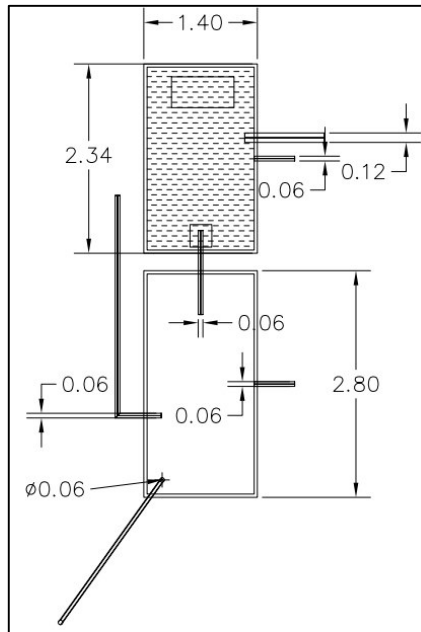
Plano Estructural Tanques de Captación Vista Superior
